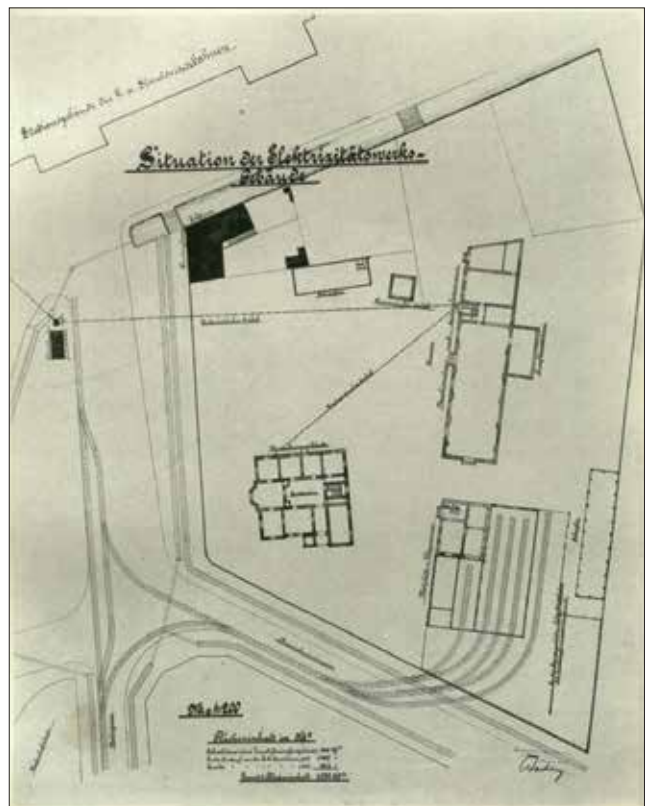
Planul remizei de tramvaie din strada Uzinei (1906)
